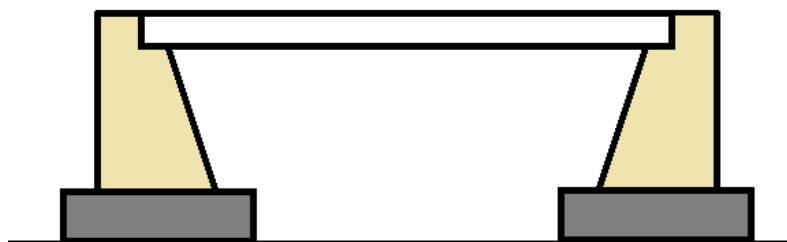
Diagrama esquemático de uma viga (ponte) biengastada.
